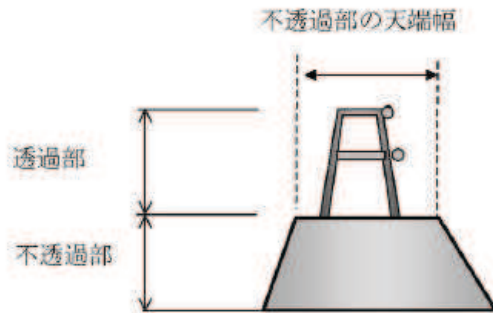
部分透過型砂防堰堤越流部側面図(例)
